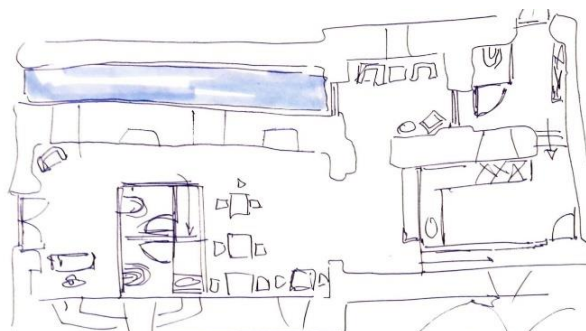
Planta de estudo; Fonte: Mariana Vieira.
